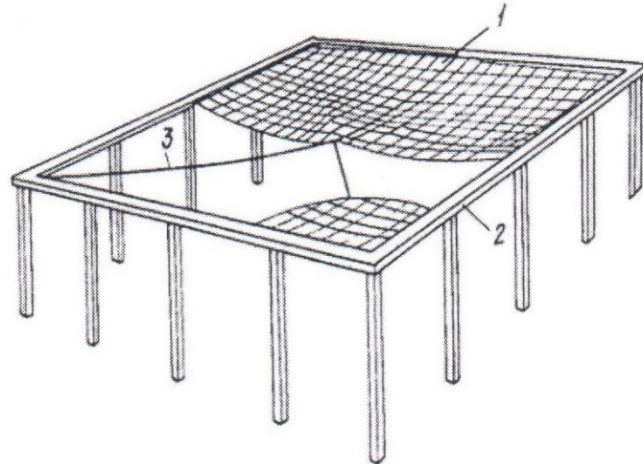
Конструктивная схема покрытия прямоугольного в плане из переплетенных лент с подкреплением. 1 – мембрана из переплетенных лент; 2 – опорный контур; 3 – подкрепляющая система
